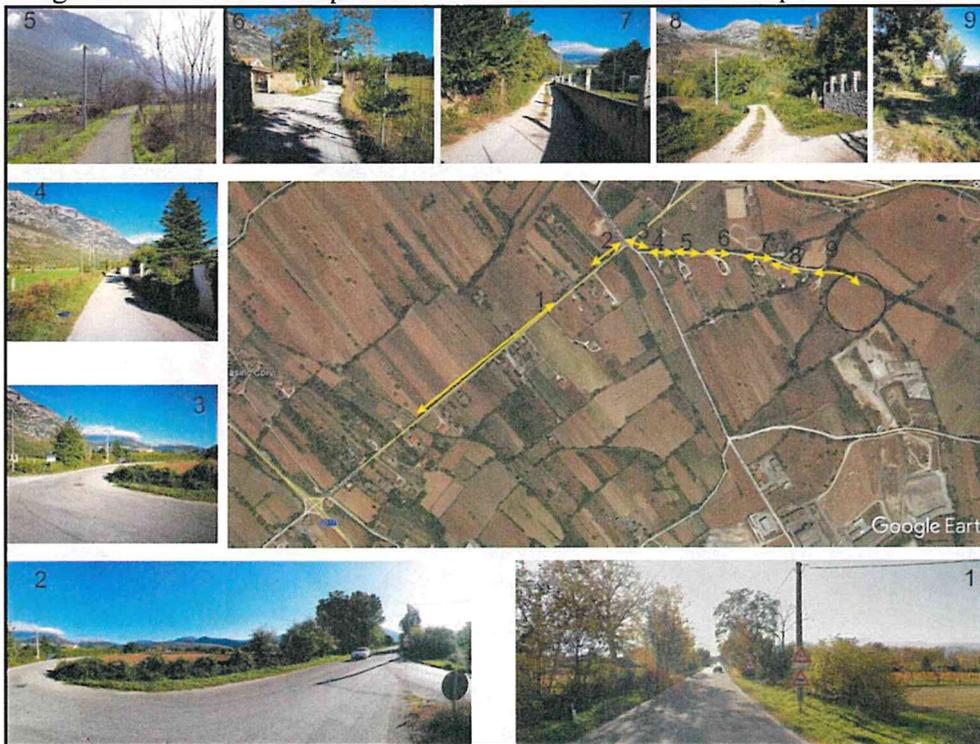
Viabilità di accesso all'area di cantiere (da Relazione generale).
